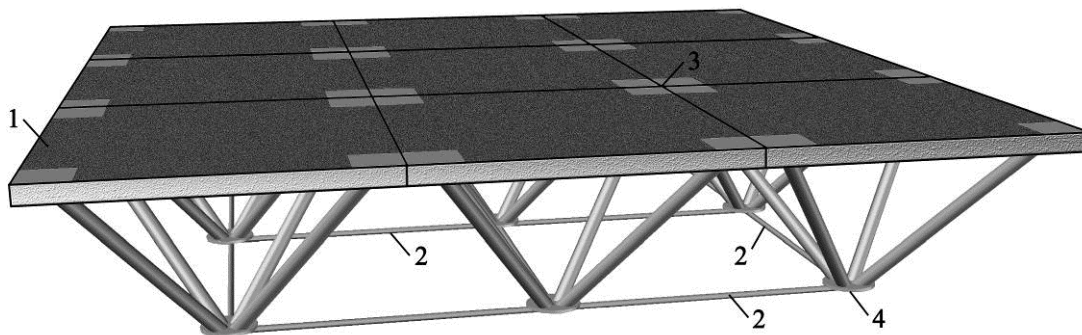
Фрагмент сталезалізобетонного структурно-вантового покриття / Part of steel and concrete composite grid-cable roof:
